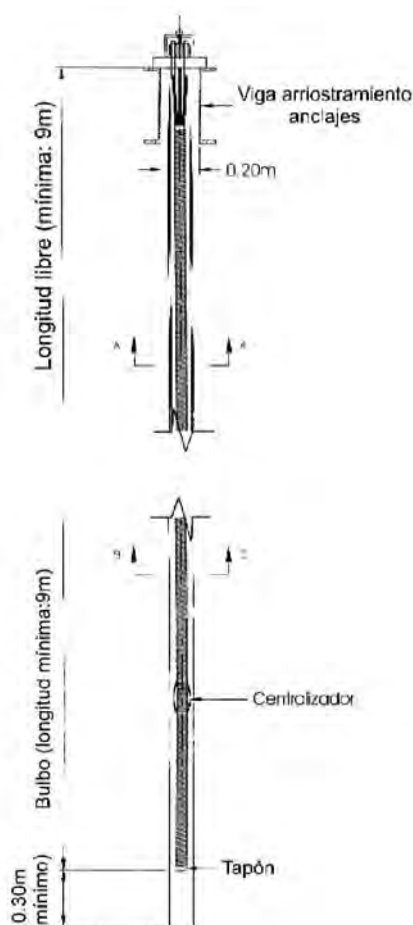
SECCIÓN LONGITUDINAL ANCLAJE
